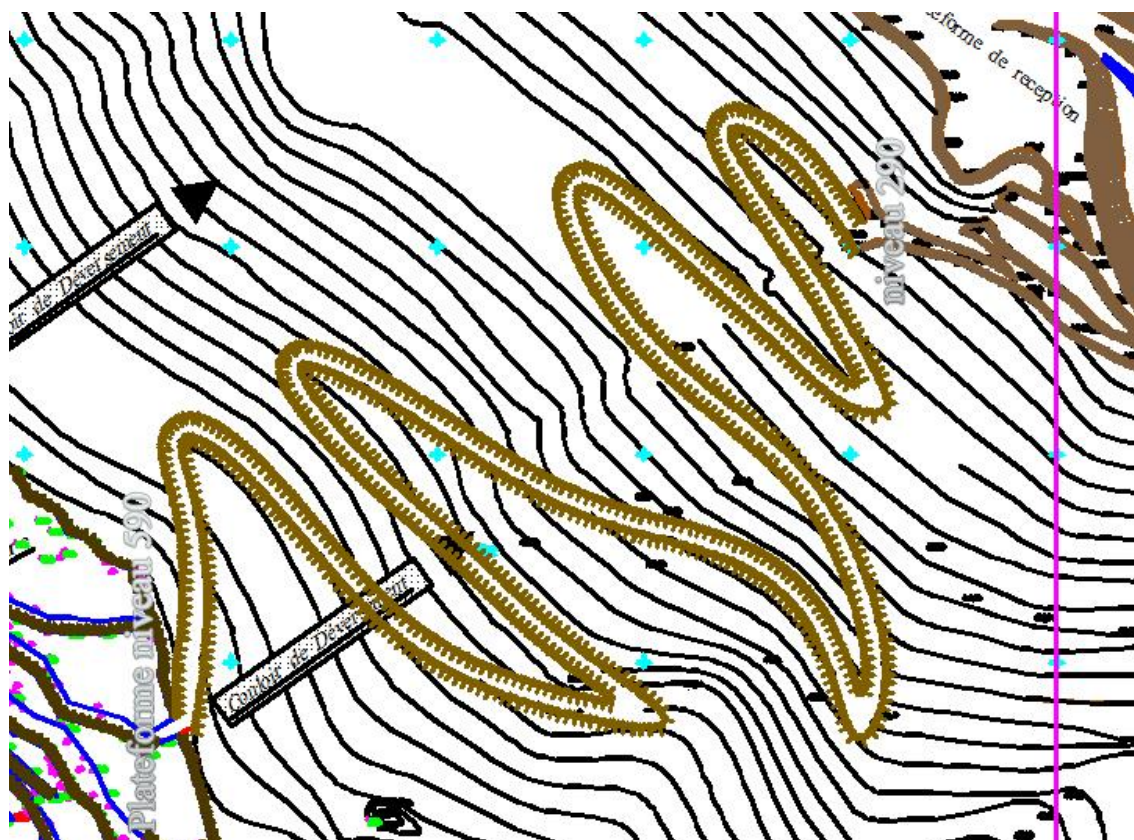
plan schématique de la piste proposé 1/1000^e (voir le plan d'arpentage en annexe)
